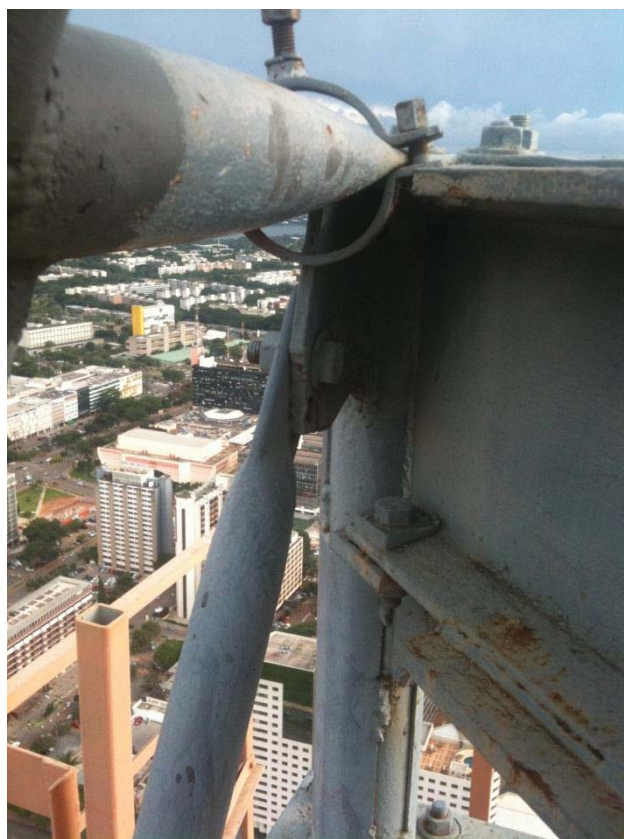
Detalhe da Transição do Trecho III (Fonte: Autor)
